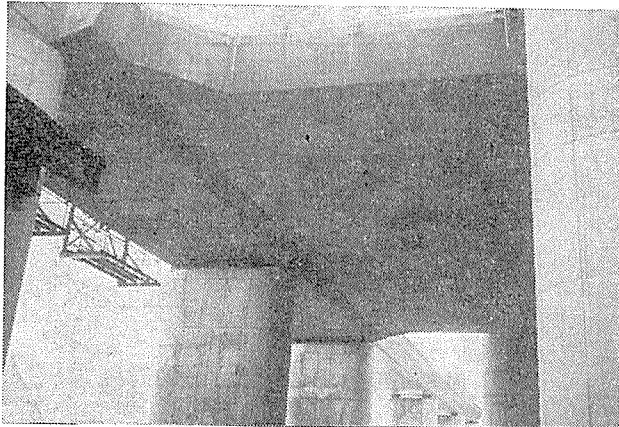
防食パネルを施工した北陸自動車道親不知海岸高架橋ランプ橋の上部工
